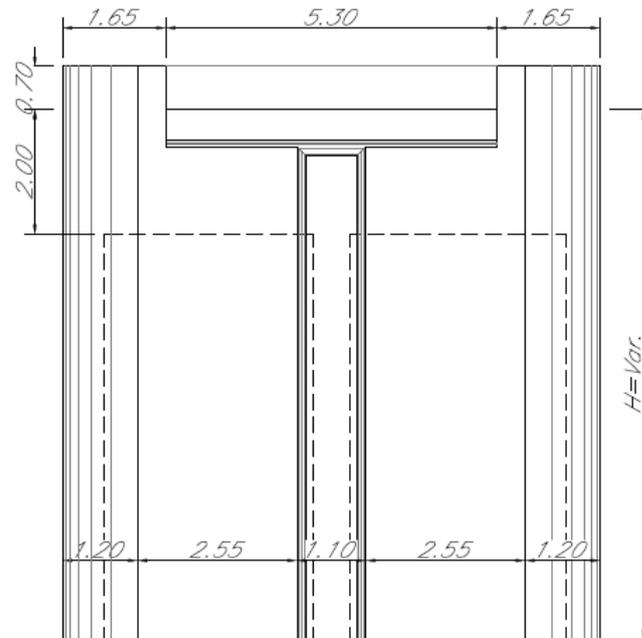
Prospetto trasversale pila Bicellulare singolo binario 8.60m x 3.40m
